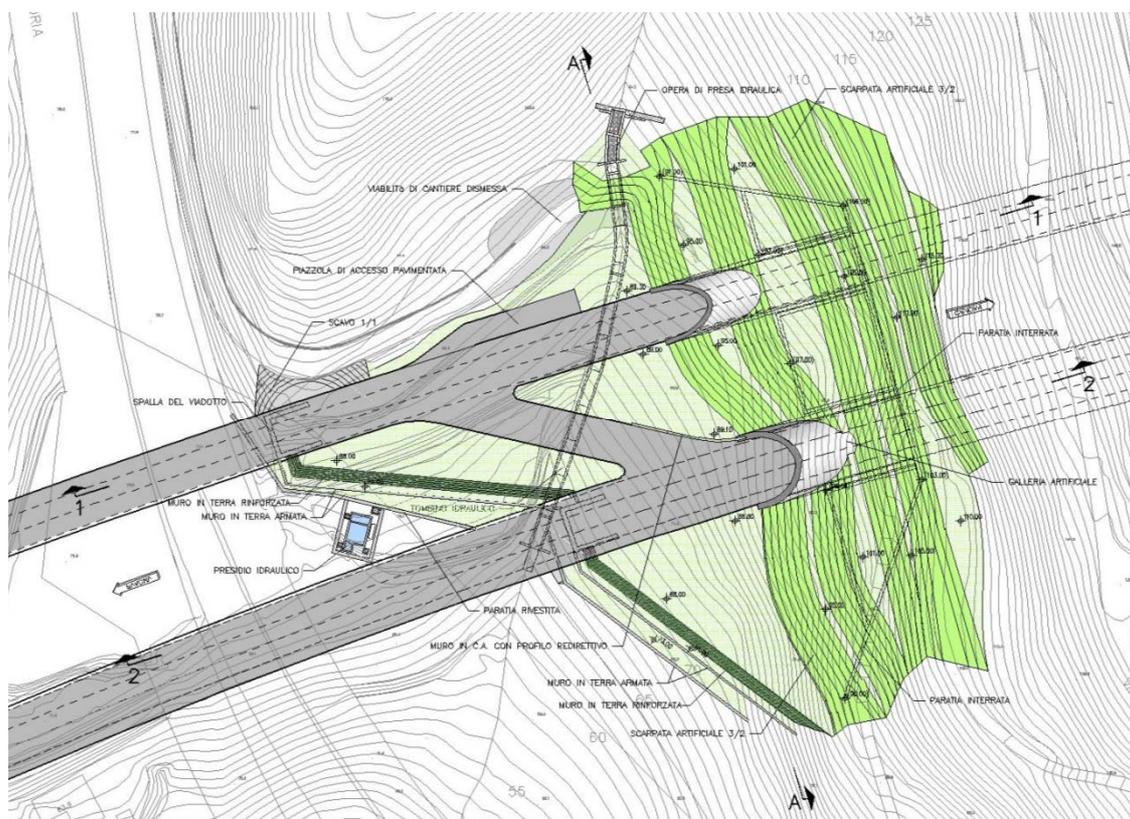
Planimetria della sistemazione finale (cfr. AUA0116-2)
